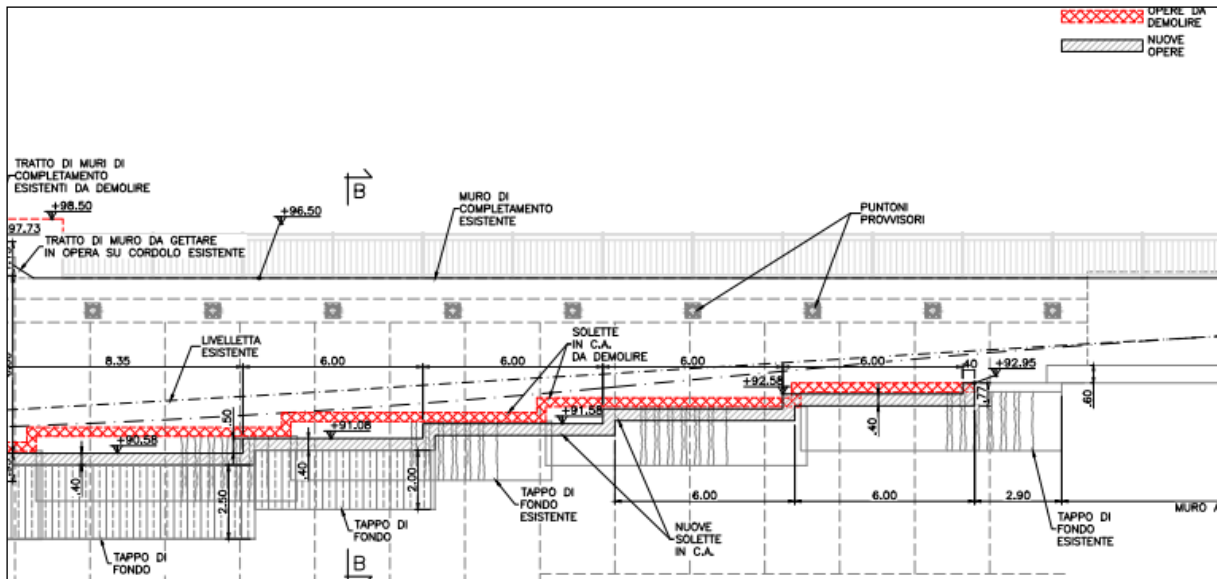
Sezione longitudinale delle opere esistenti e da realizzare
